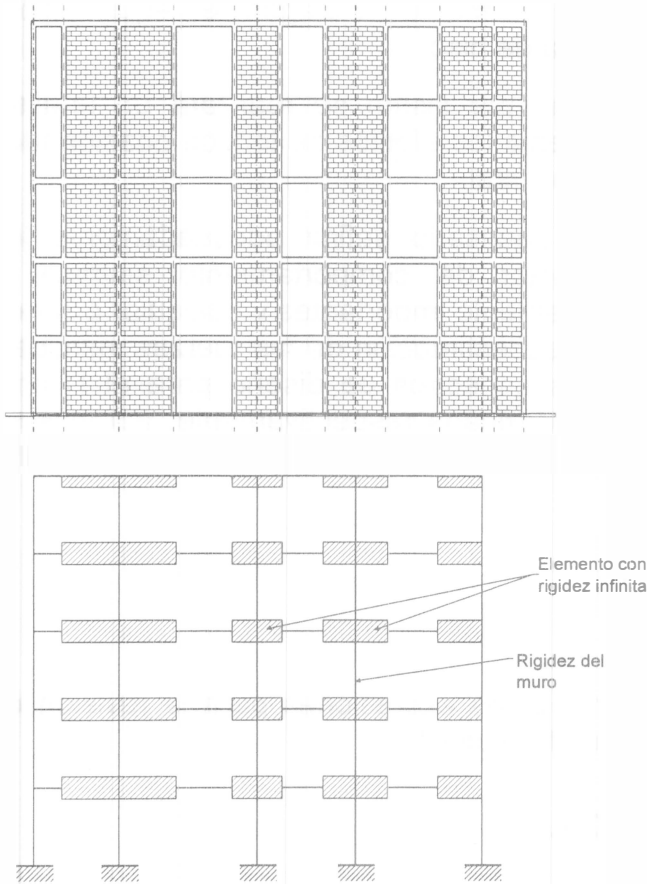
Modelo de marco para un muro de mampostería utilizando la analogía de la columna ancha.
